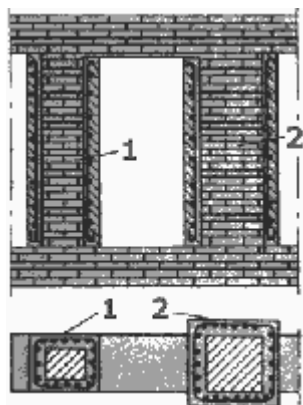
Усиление простенков железобетонным корсетом:1, 2 - простенки, усиленные железобетонным корсетом с увеличением сечения стены.
